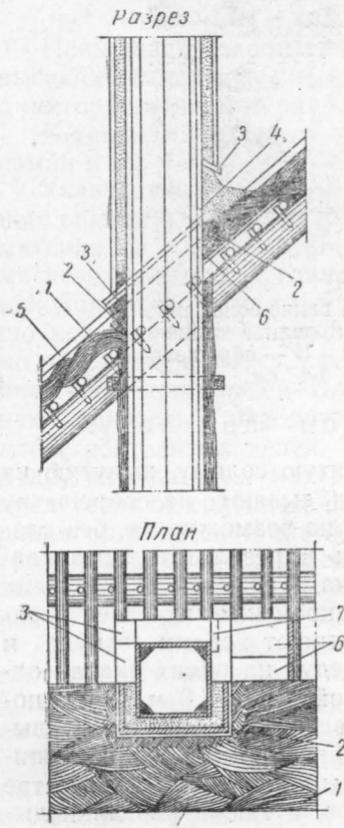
Обделка вентиляционной трубы в глино-соломенной кровле:
